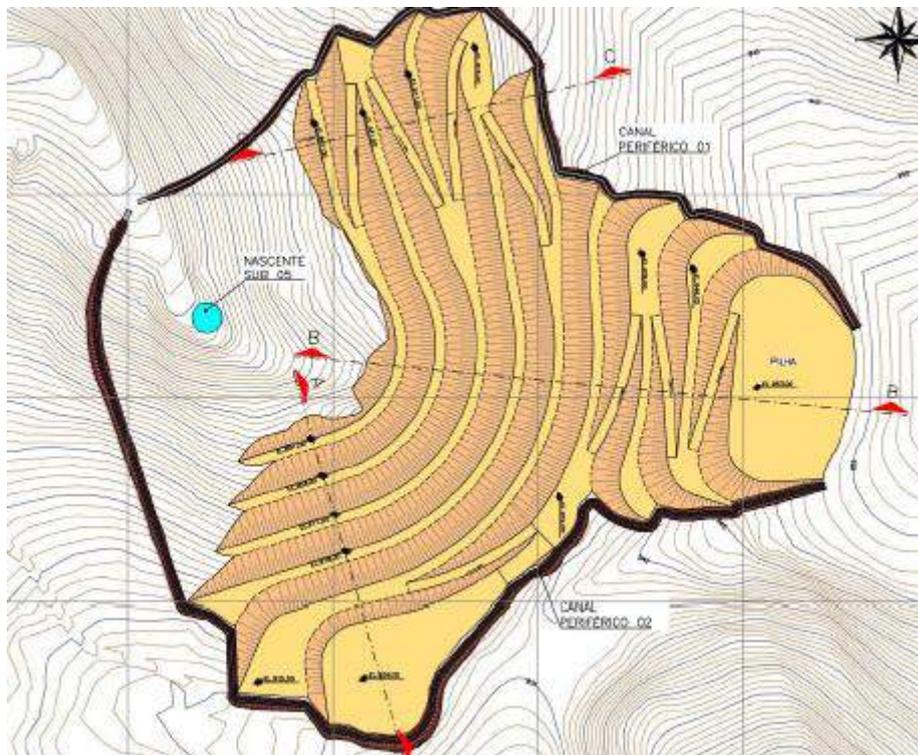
Localização das seções críticas da estrutura da pilha da Pilha ADME-01.
